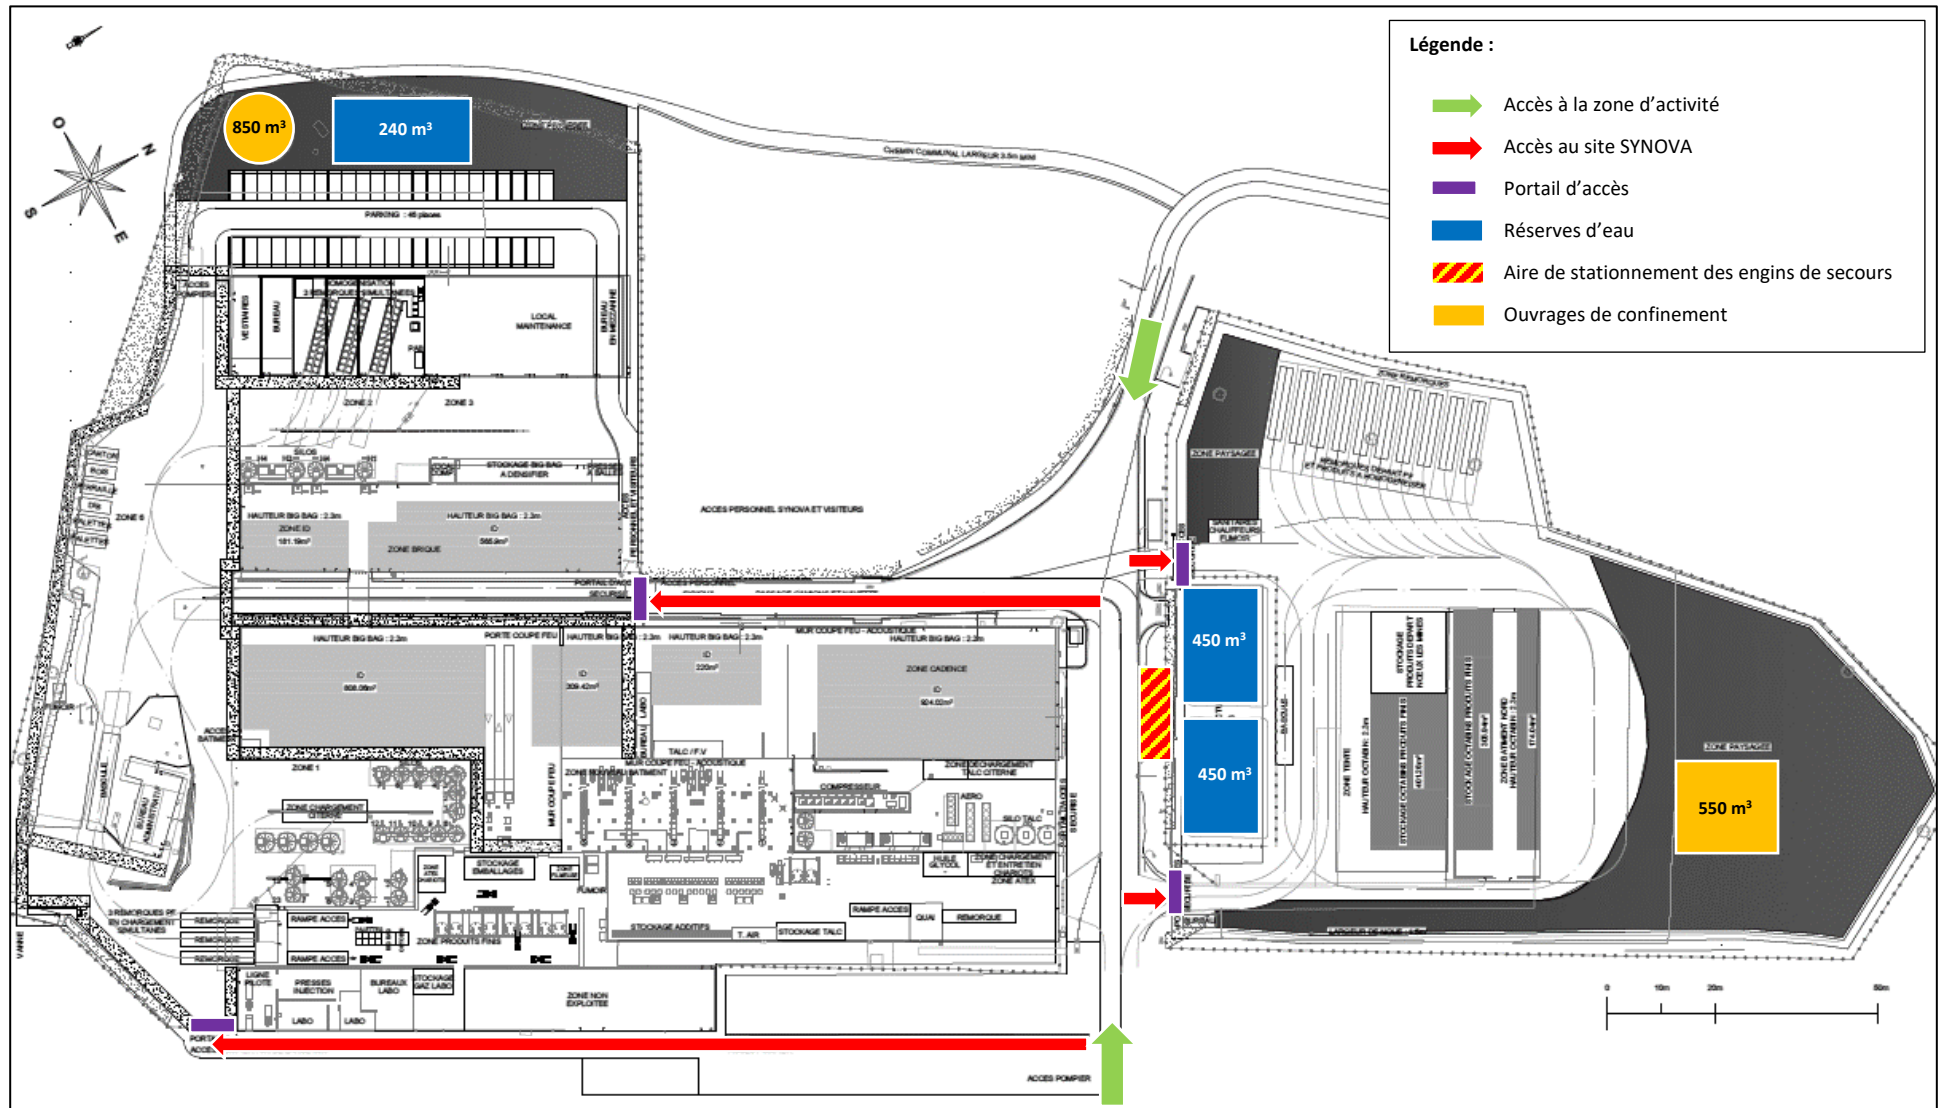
PLAN D'INTERVENTION DES SECOURS
